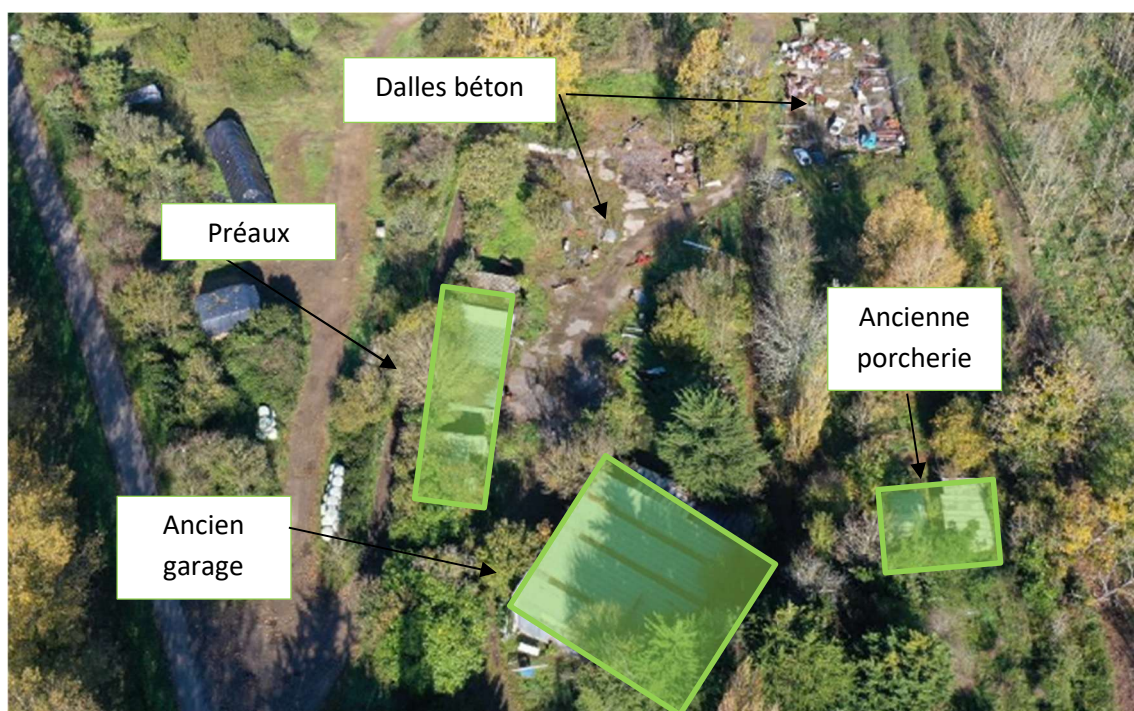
Ensemble de bâtiments au Sud-Est du site
